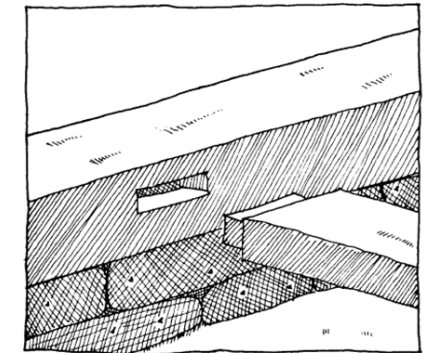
Detalle de unión de envigados de piso con viga maestra en Stavkirke. Fuente: Norwegian wood: A case study of stave churches. Fuente: Harris (1982).
